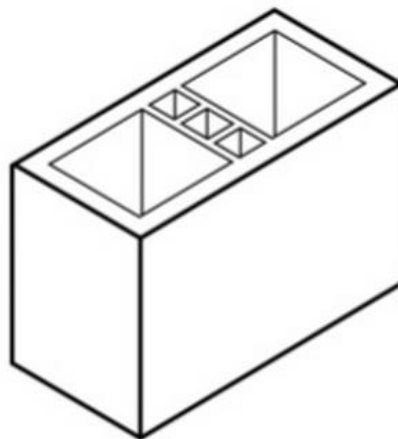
Bloco cerâmico estrutural de paredes vazadas.
